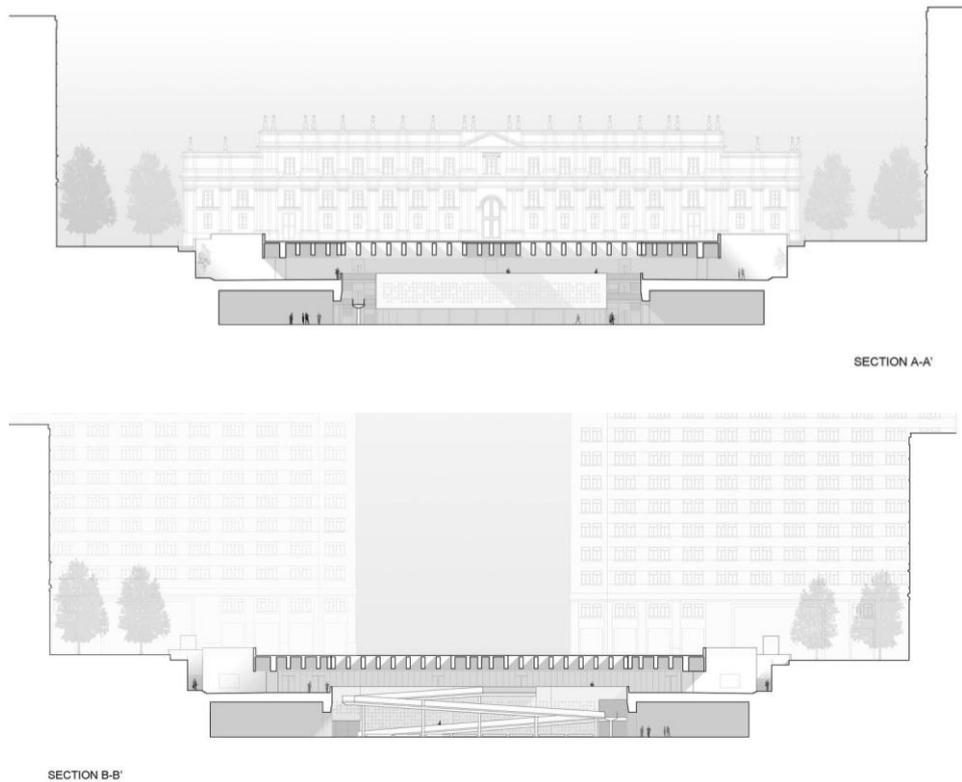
Cortes de las secciones A-A y B-B. Fuente: Archdaily, 2006. Elaboración: Imagen de cortesía de Undurraga Devés Arquitectos, 2006. Blog Diseño Arquitectura.
